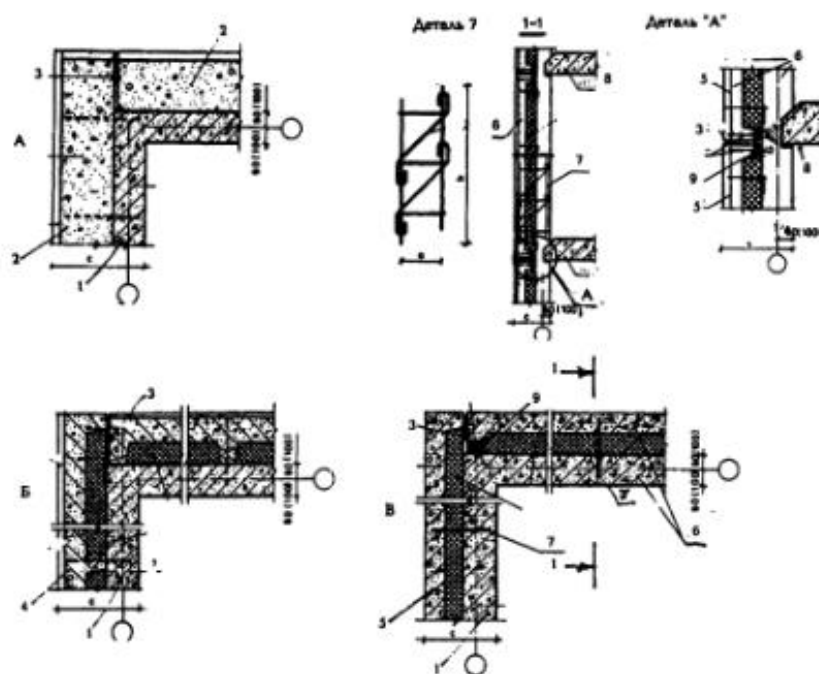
Монолитные наружные стены с утепляющими и отделочными наружными навесными панелями - скорлупами: а - однослойная из легкого бетона; б - двухслойная из конструктивного легкого бетона с эффективным утеплителем; в - то же, из тяжелого бетона; 1 - внутренний слой наружной стены из монолитного бетона; 2 - однослойная панель - скорлупа; 3 - герметик; 4 - двухслойная панель; 5 - то же, из тяжелого бетона; 6 - тяжелый бетон; 7 - стальной оцинкованный каркас; 8 - сборная плита перекрытия; 9 - эффективный утеплитель.
